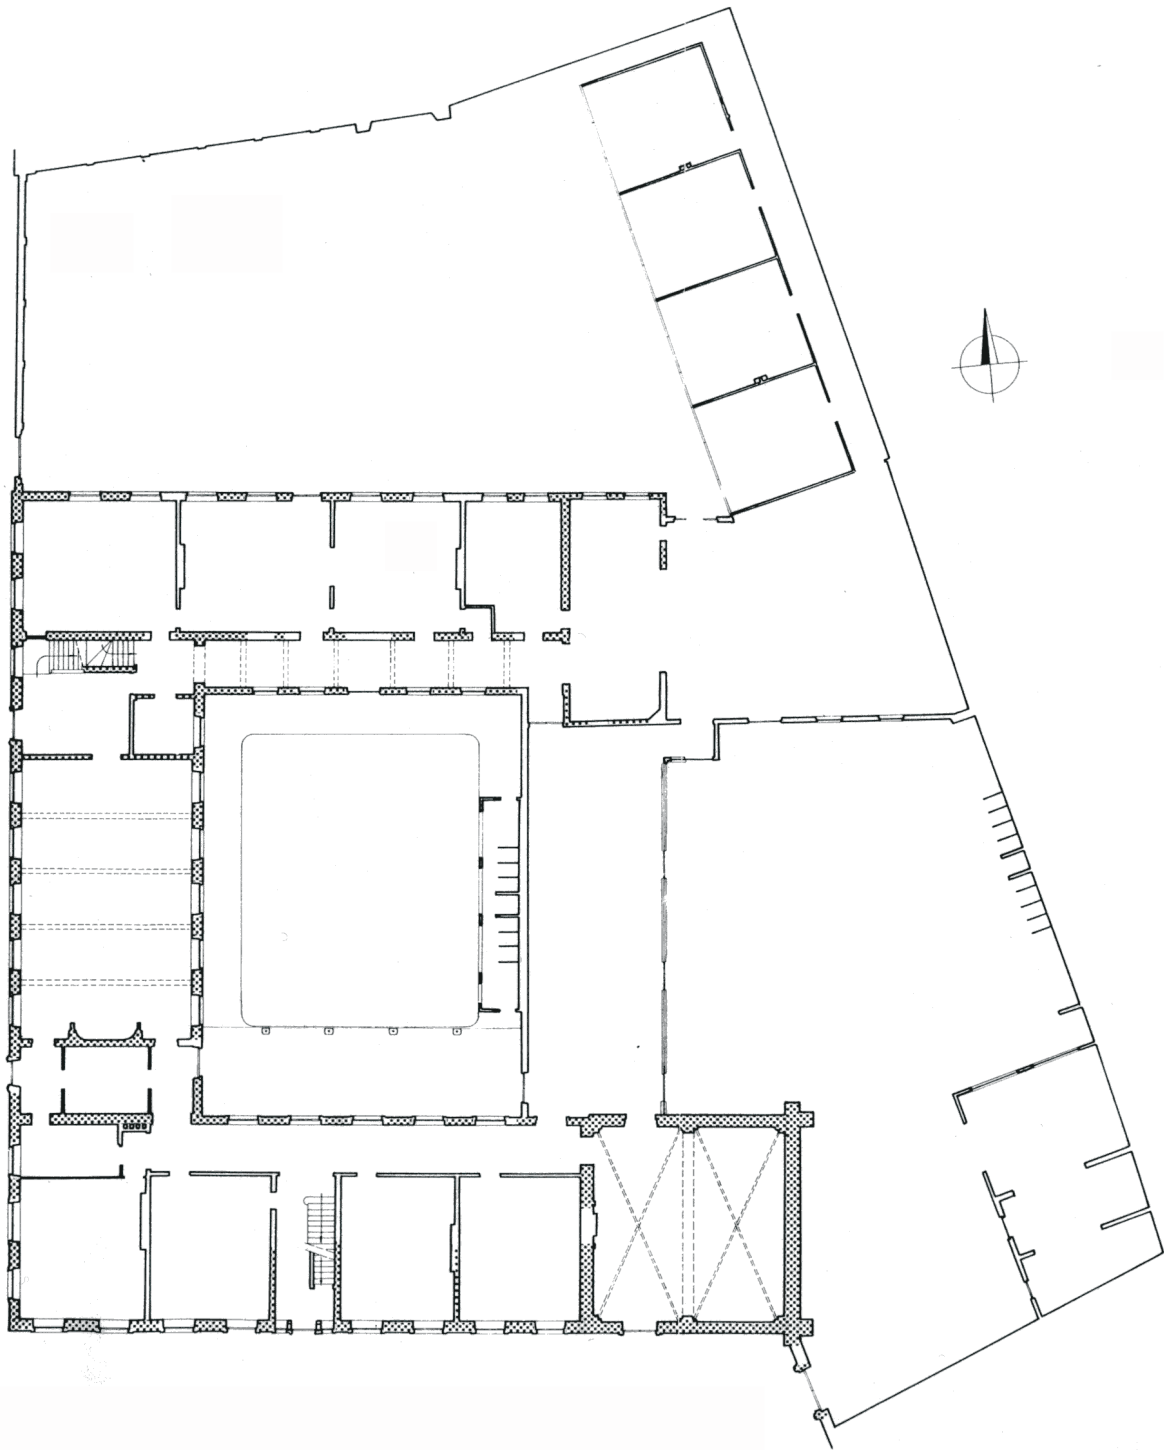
(Gent, K5) Grundriss des Meisterinnenhauses mit der Infirmierie (rechts unten), aus: Bouwen door de eeuwen heen, Inventaris van het cultuurbezit in België. Architectuur. Deel 4nb Stad Gent. Zuid-West, Ministerie van Nationale Opvoeding en Nederlandse Cultuur, Gent 1979, Abb. IV, S. 35, Zeichnung Technische dienst schoolgebouwen, Stadt Gent.
